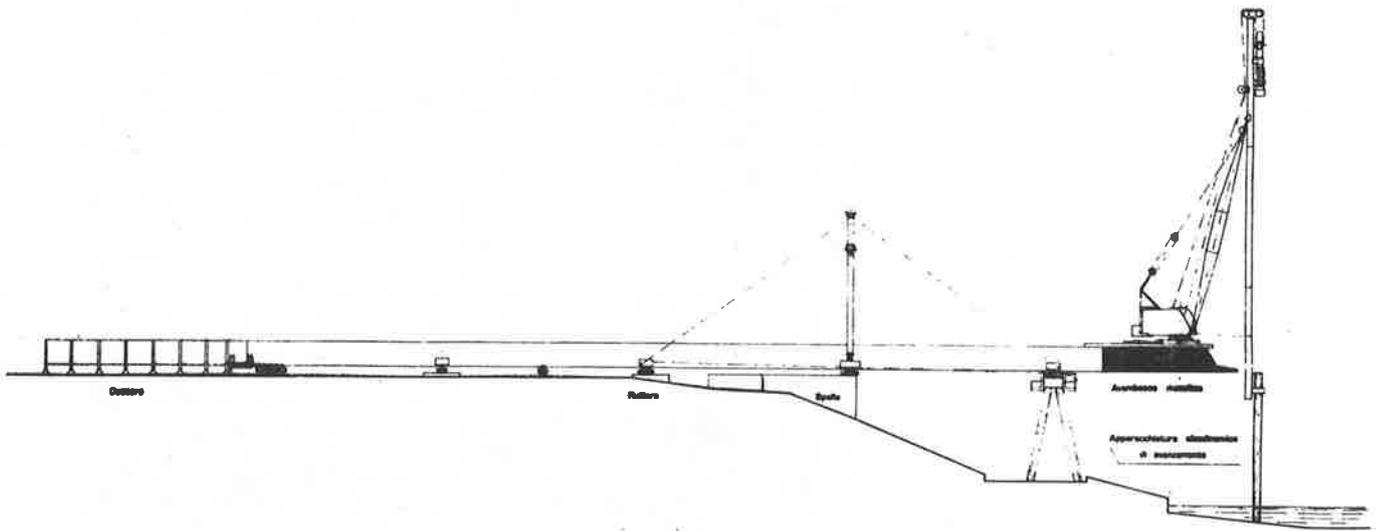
Pontile SARAS - Sistema costruttivo: cassero, rulliere, apparecchiatura di avanzamento, avambecco metallico con battipalo
